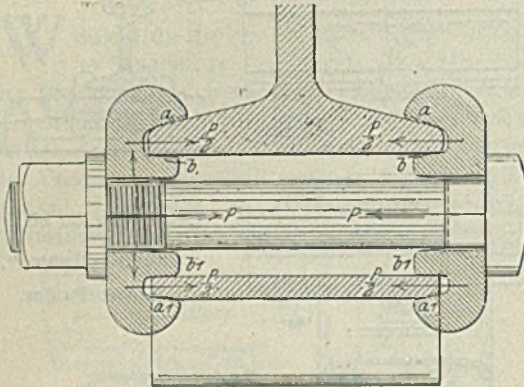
Wirkung des Schraubenzuges auf die Klauen zur Festhaltung des Stemmstücks.
